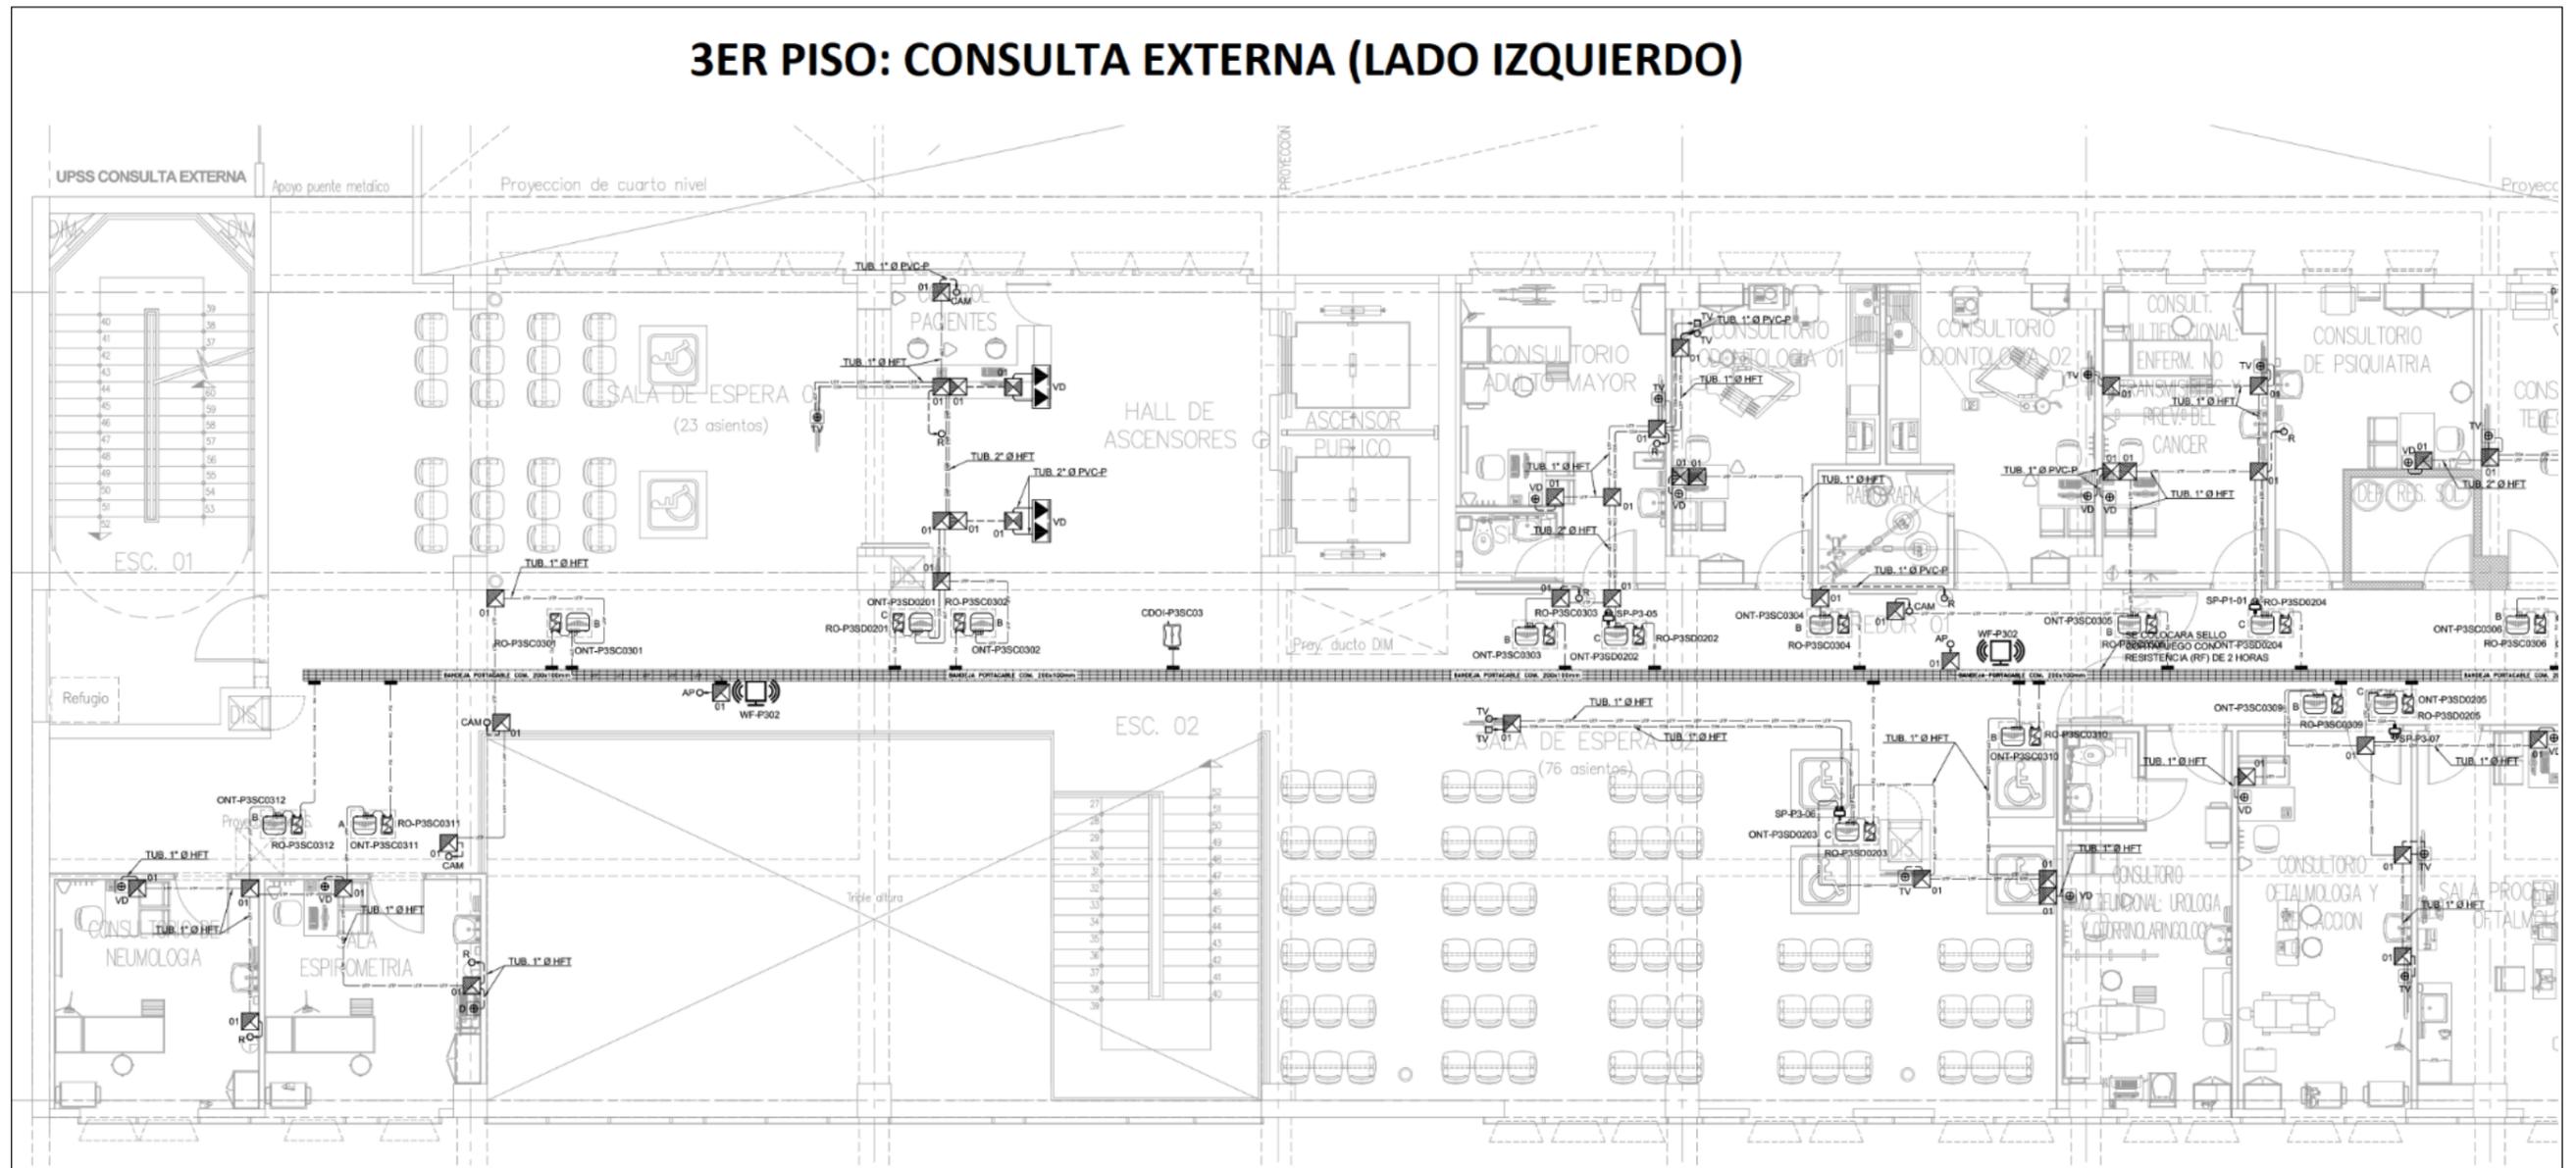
Plano técnico 3er piso: Consulta Externa (lado izquierdo).
